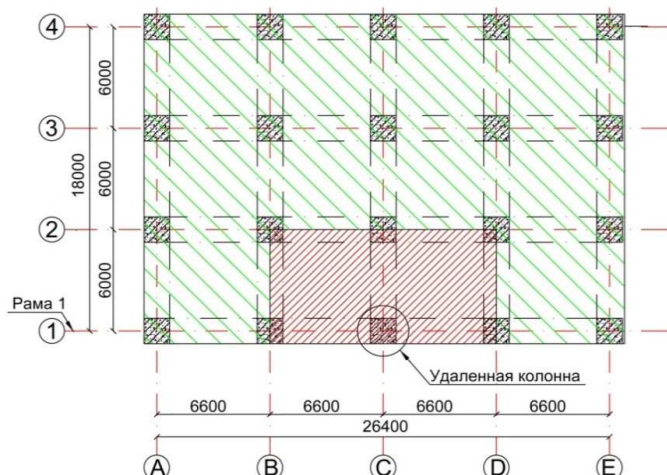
План первого этажа 25-ти этажного каркасного железобетонного здания
